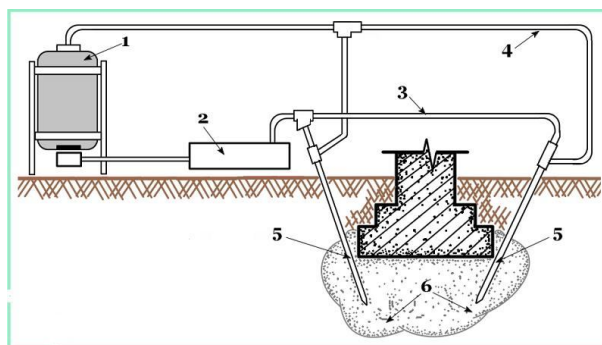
Підсилення фундаментів закріпленням слабого шару ґрунту:
